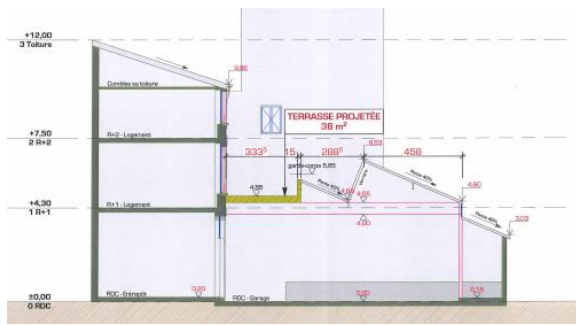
Exemple d'un projet de création d'une terrasse tropézienne sur le toit d'un bâtiment industriel
